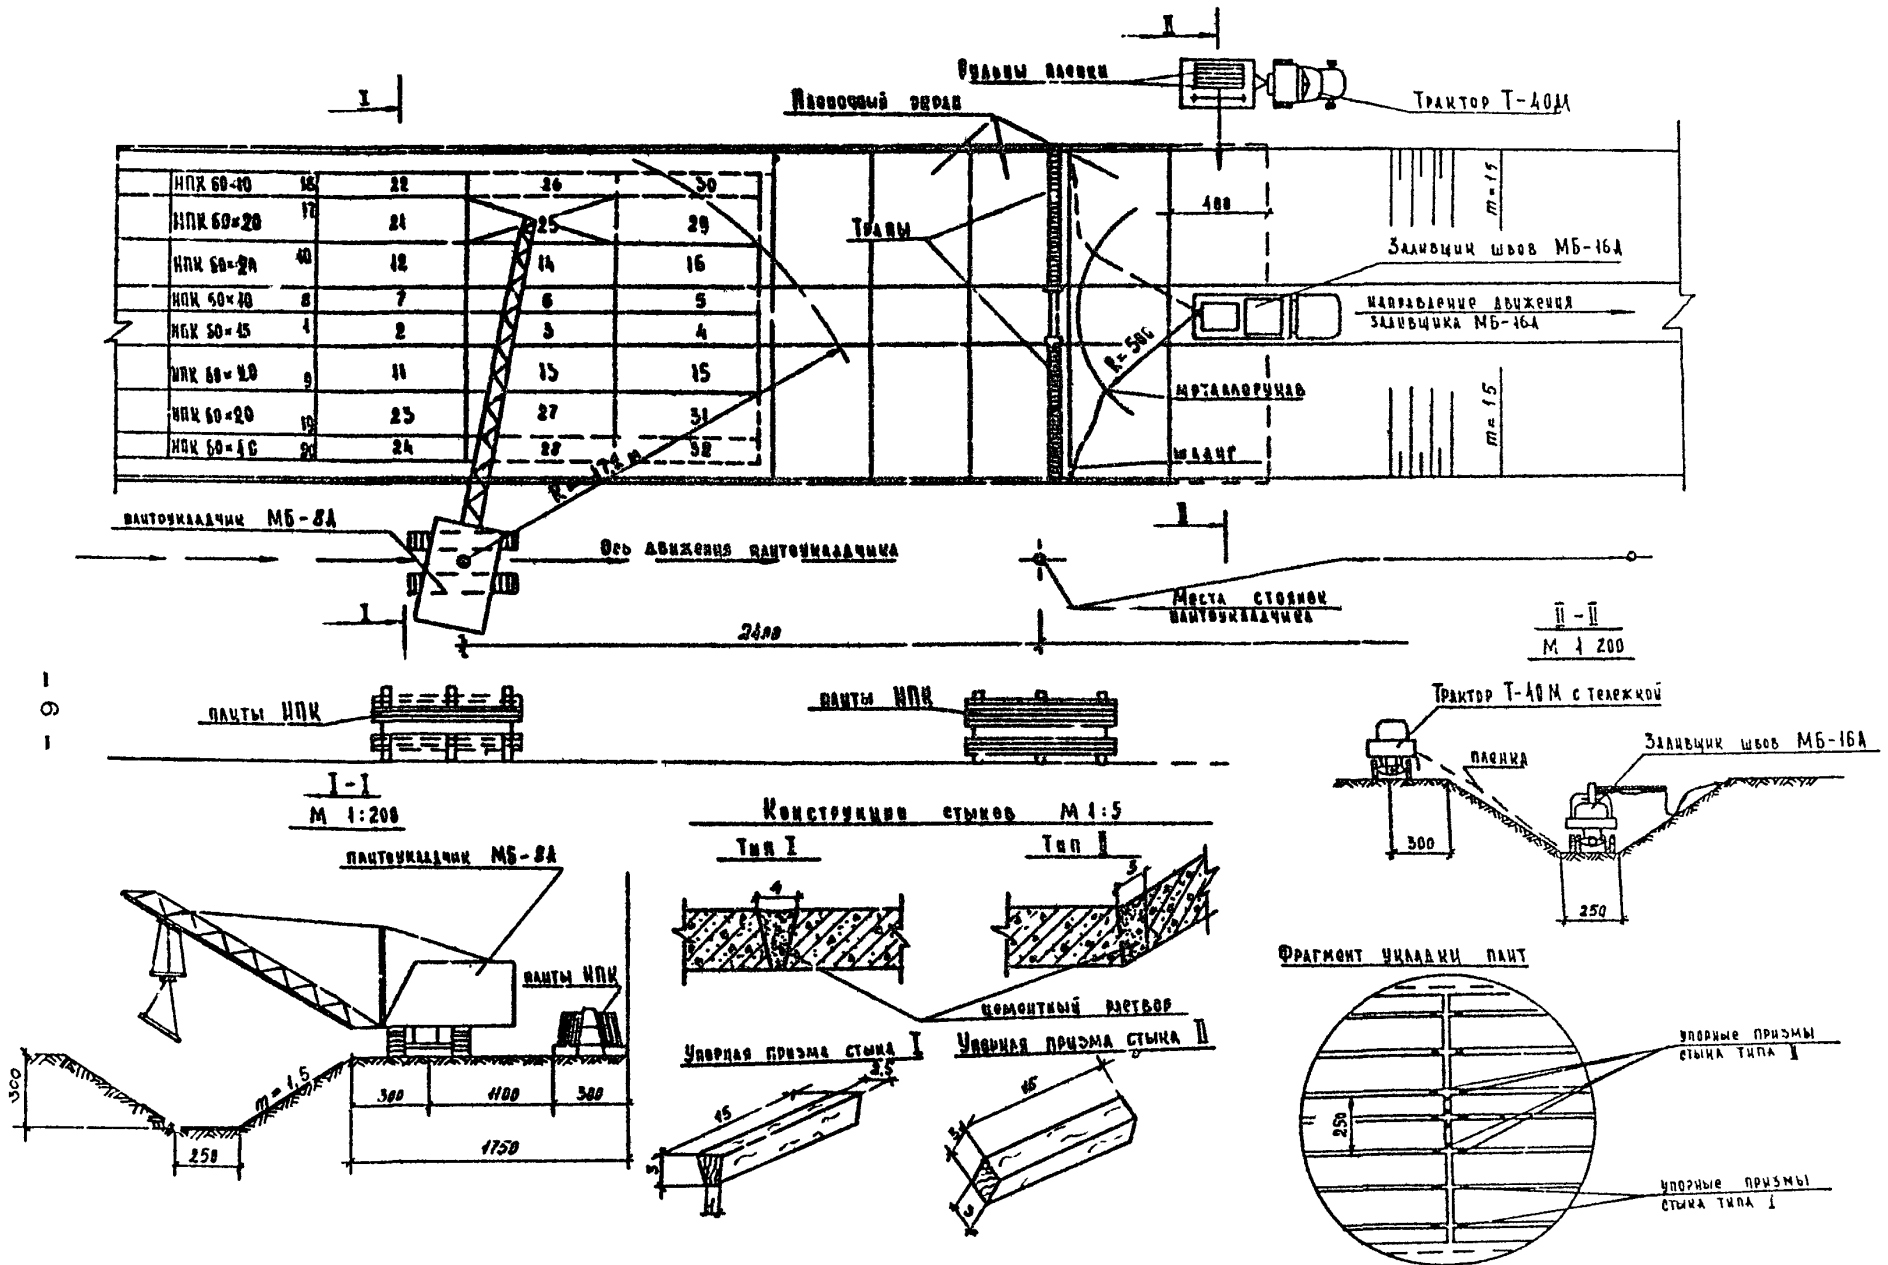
Схема устройства плетеного экрана и монтажа плит
